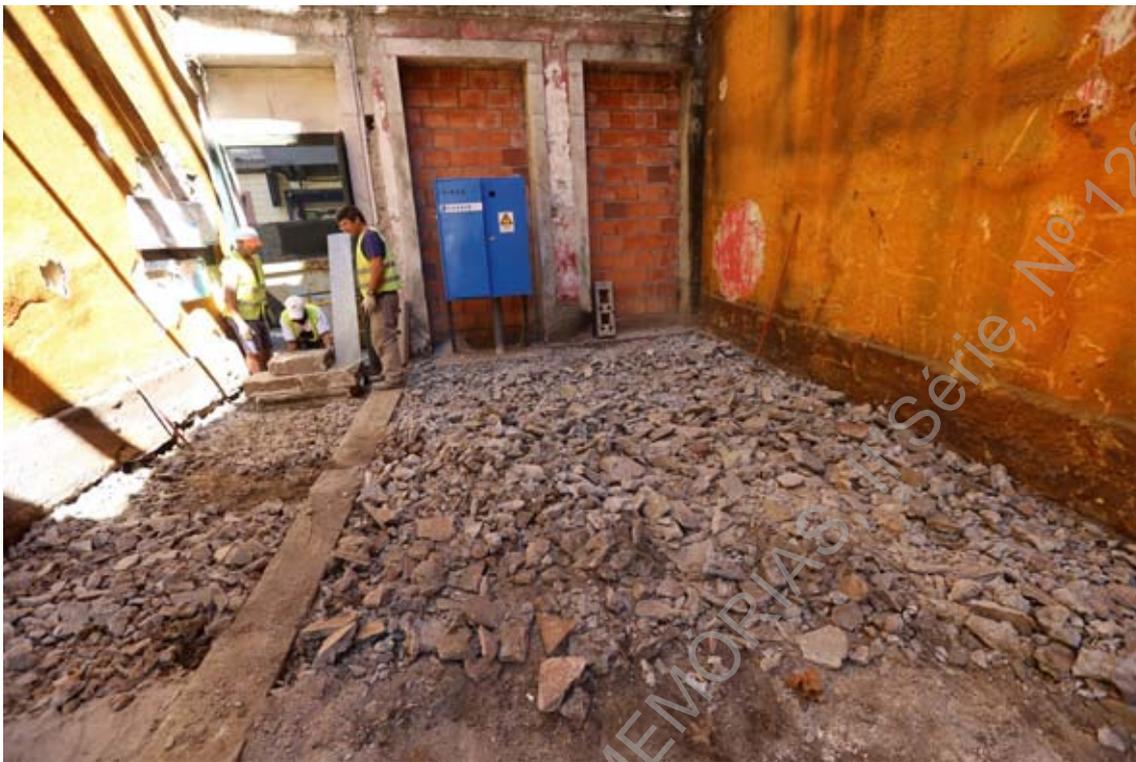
(IMG_9665) – Levantamento do pavimento em cimento (UE023) do lote.
